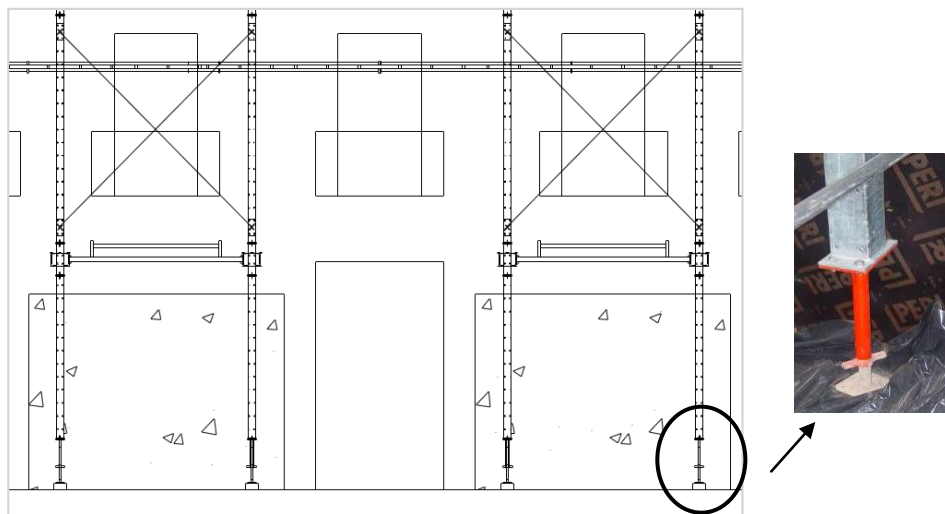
Pie STA embebido en los contrapesos de hormigón (Fuente: PERI sistemas de encofrados y andamios)
